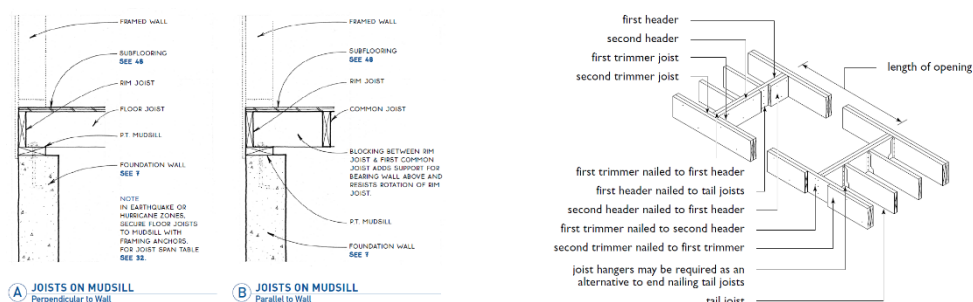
Estrutura de pavimento característica (Thalon, 2009) e reforço para abertura de vão no pavimento (CMHC, 2013a).
